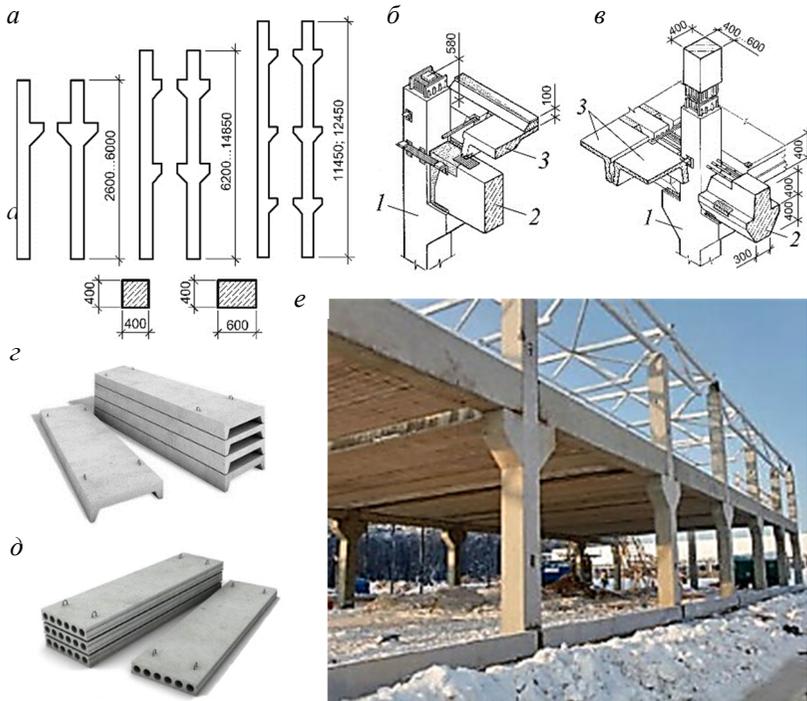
Каркас многоэтажных промышленных зданий: *а* — виды колонн; *б* — узел опирания на консоль крайней колонны ригеля прямоугольного сечения; *в* — то же, средней колонны ригеля двухполочного сечения; *1* — колонна, *2* — ригель, *3* — ребристая плита перекрытия; *г* — ребристая плита; *д* — многопустотная плита; *е* — общий вид
